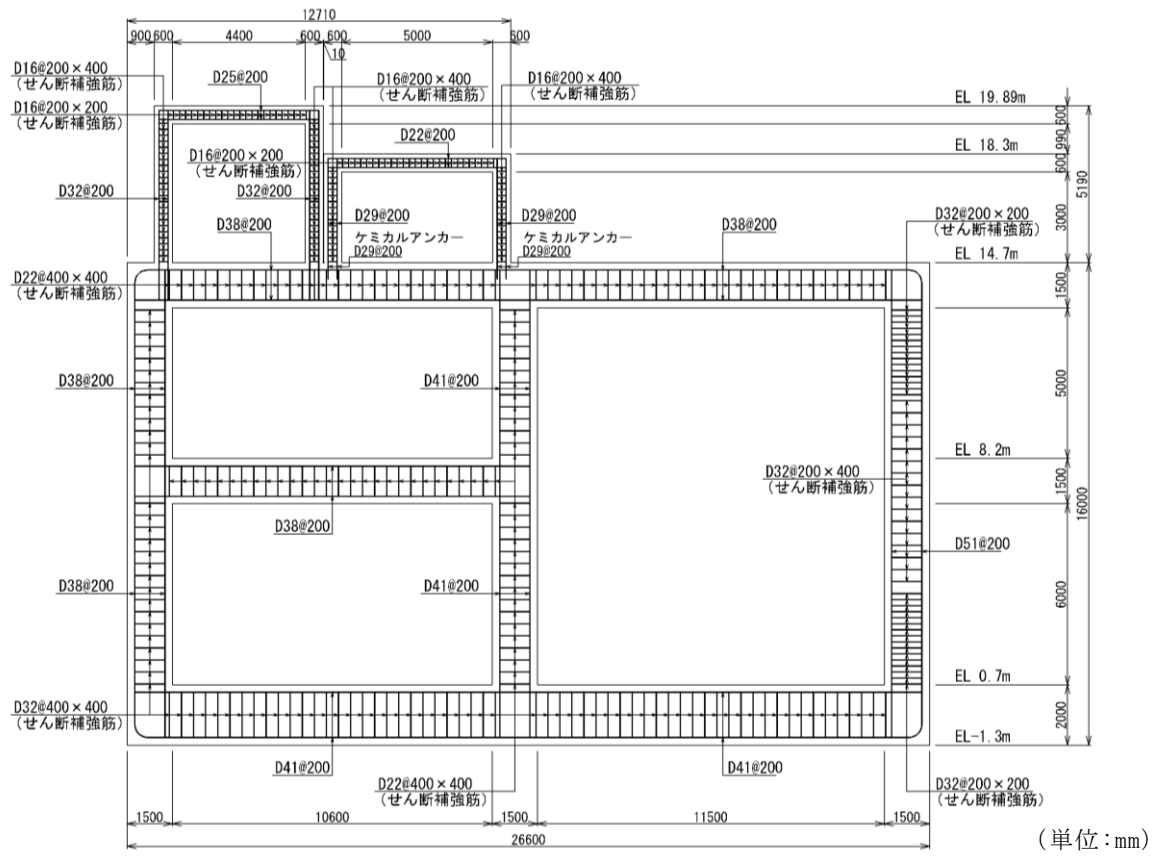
低圧原子炉代替注水ポンプ格納槽 概略配筋図 (C-C 断面)
